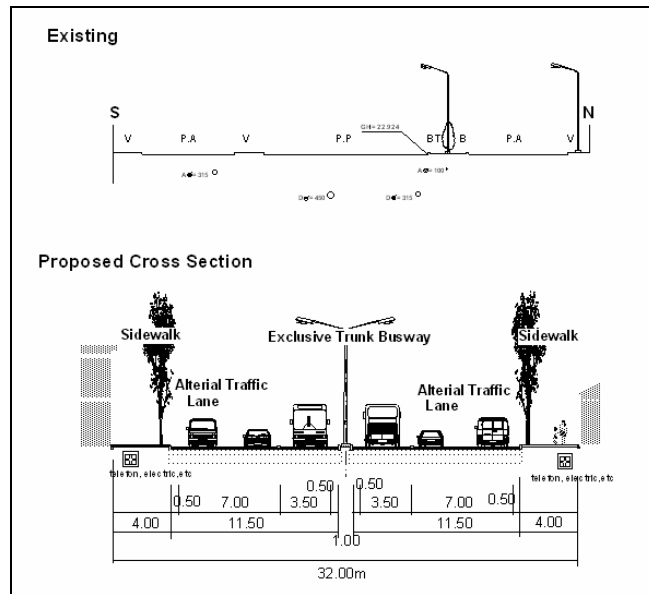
Sección Transversal Típica 32m (tipo D)
